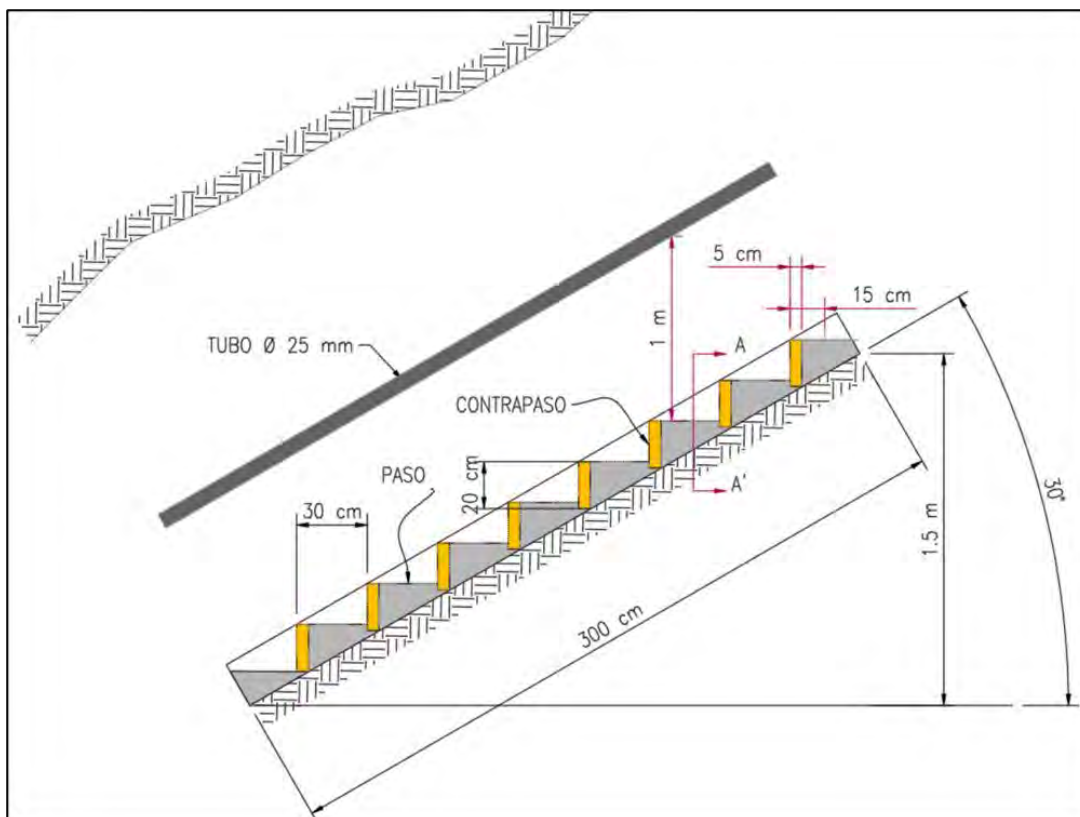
Diseño de la sección del pique inclinado 300 (vista en planta)*INSTALACION DE RIELES:
